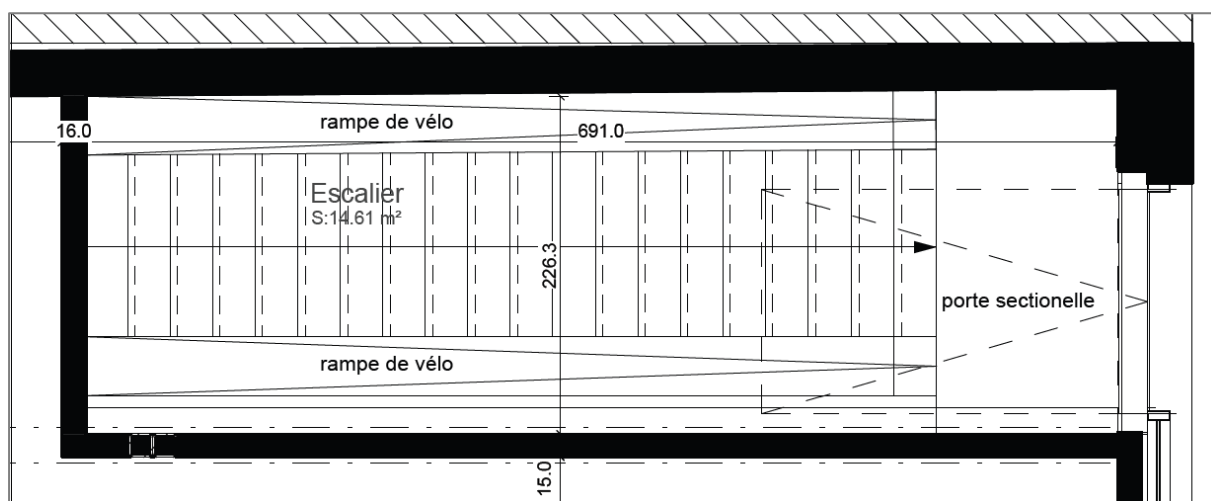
Rampes et escalier d'accès au R-1 (source : B2Ai)
